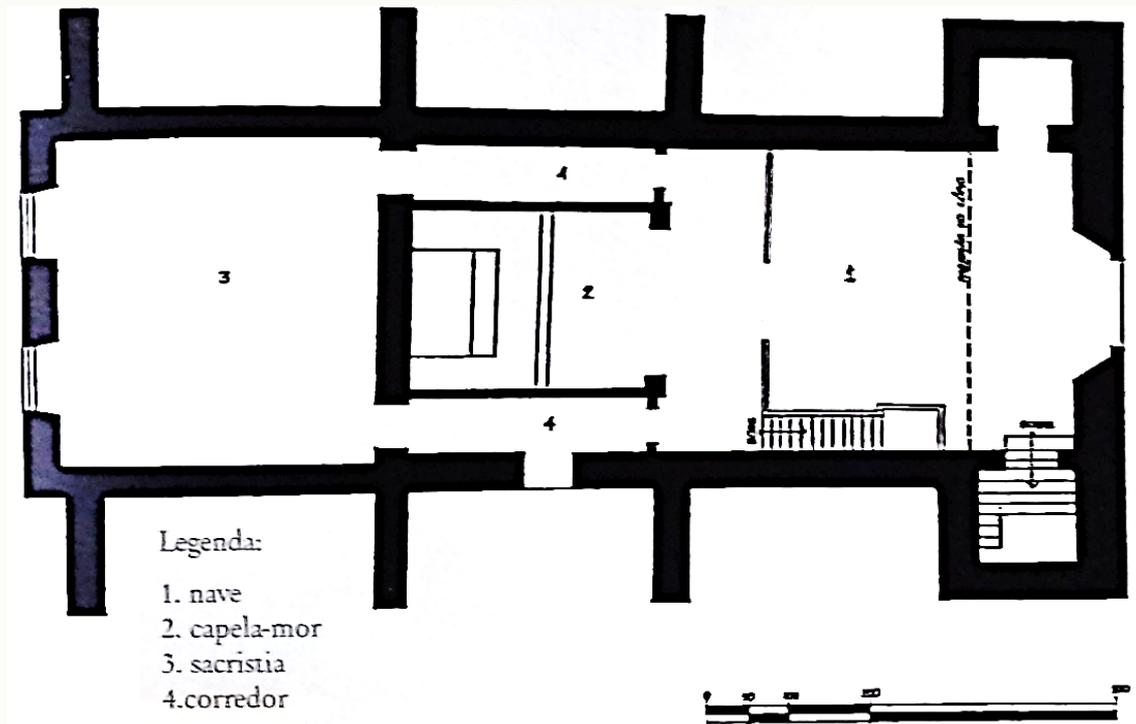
Planta-baixa da Igreja de Santa Bárbara.
